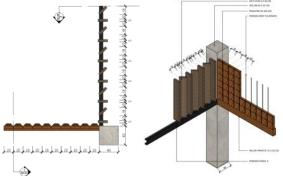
Detail Tower (Kiri: Denah; Kanan: Potongan Isometri) Sumber: Data pribadi, 2023
